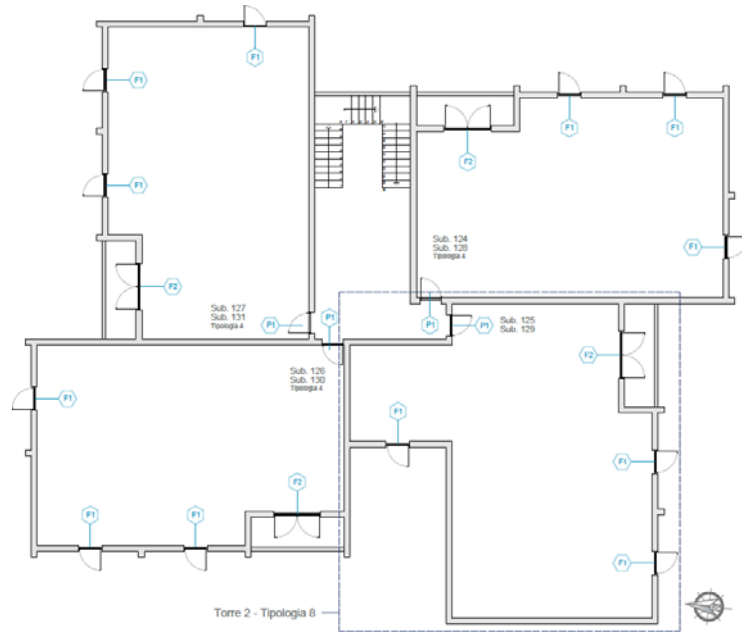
Pianta stato di fatto, piano quinto/sesto – Torre 2
